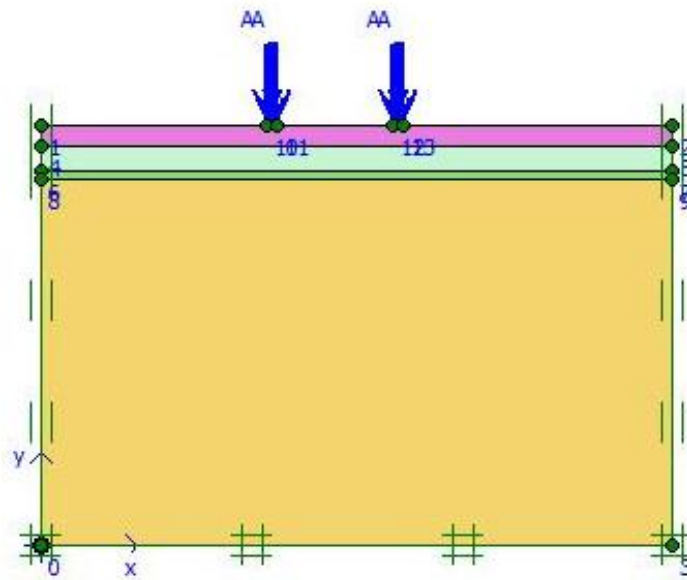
Cargas aplicadas al pavimento (Eje trasero cargado).
